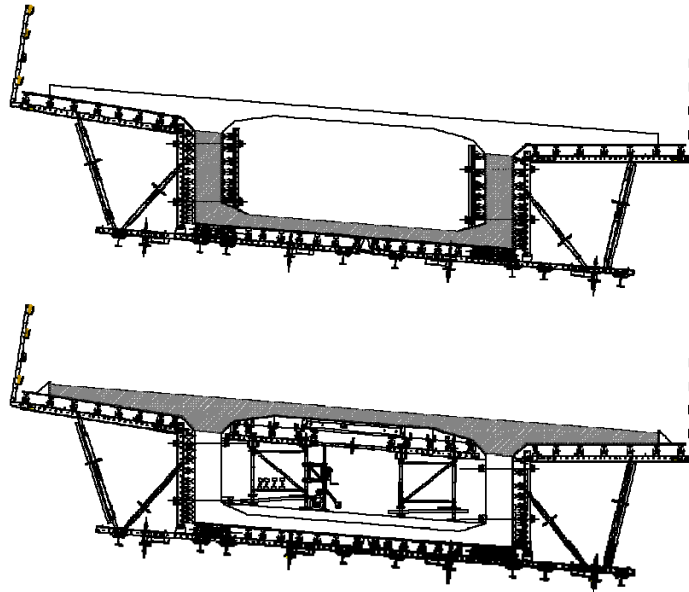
Cofragem e faseamento da betonagem: 1ª fase (cima) e 2ª fase (baixo)
